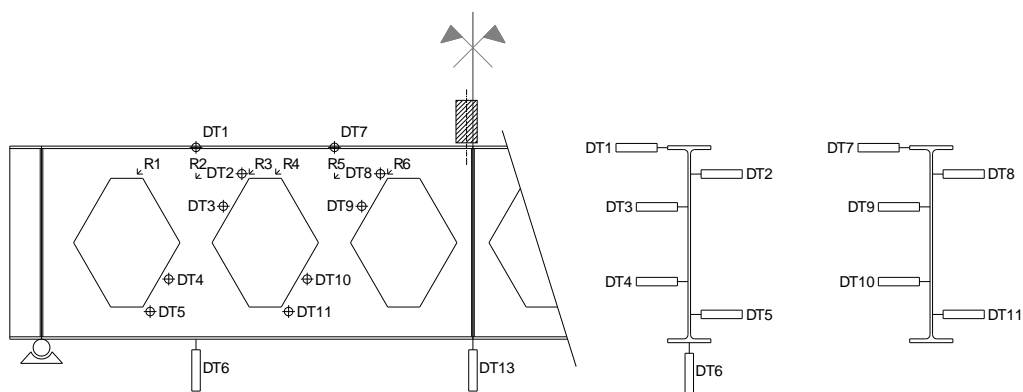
Projeto de instrumentação para as vigas do grupo B.
